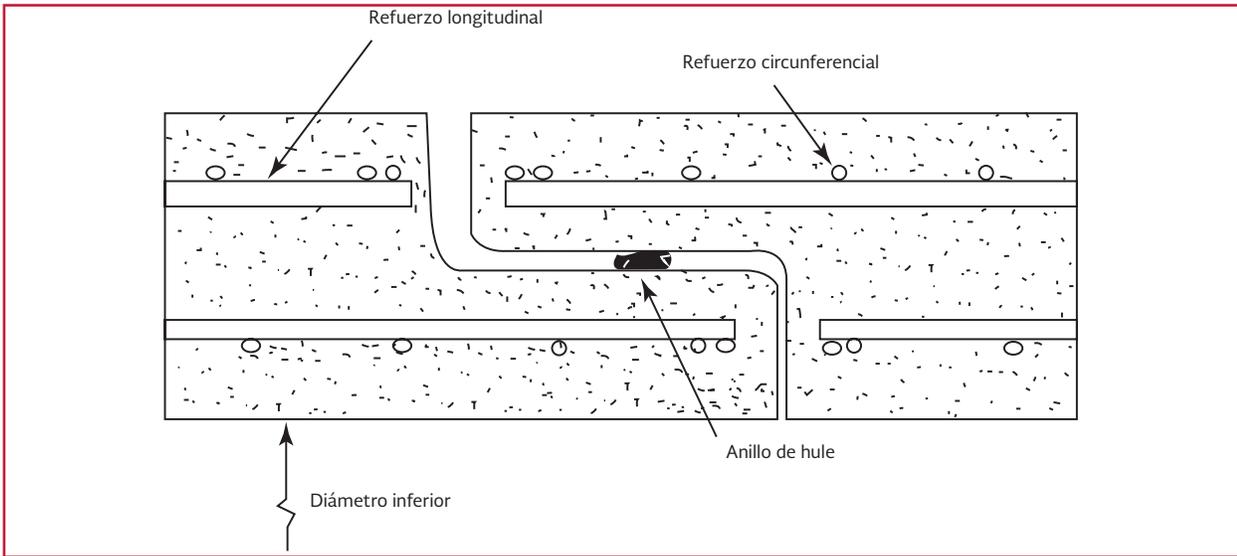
Unión espiga-campana en tubería de concreto sin cilindro de acero
